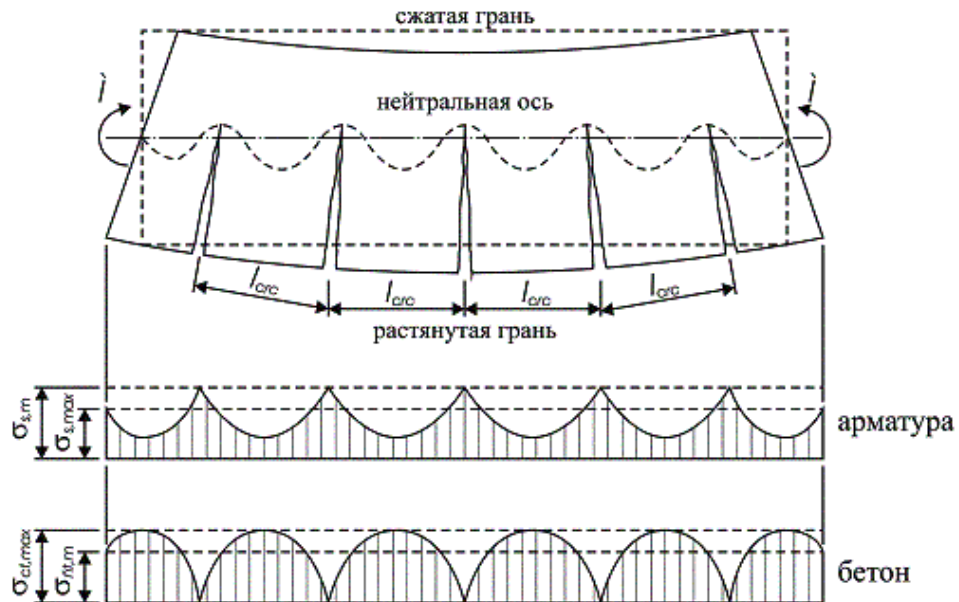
Распределение напряжений в растянутой арматуре и растянутом бетоне для железобетонной конструкции в стадии 2
